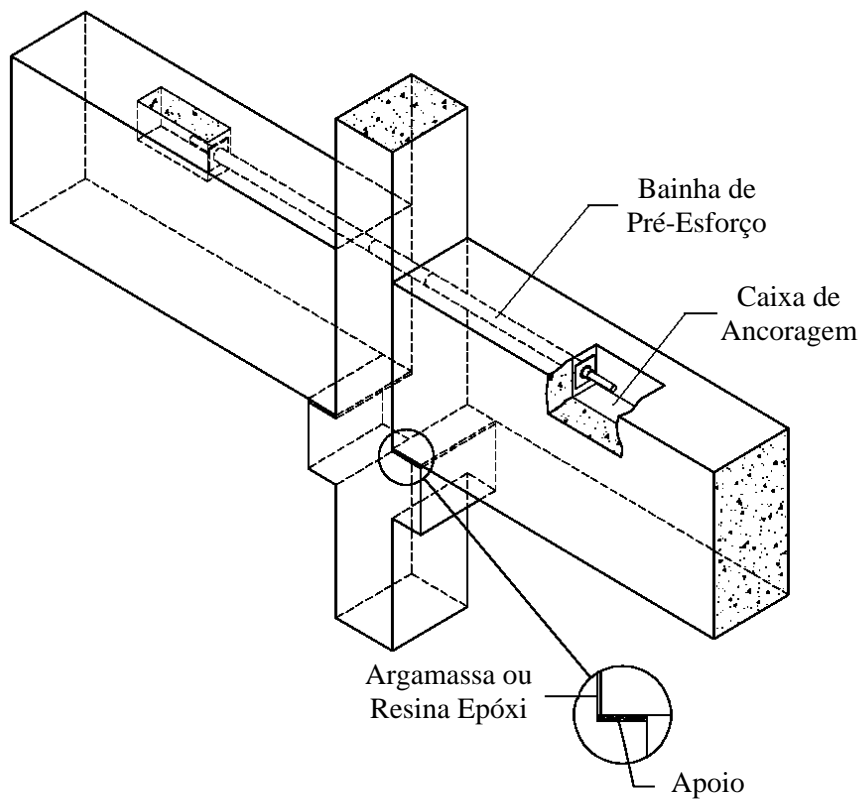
Ligação viga - pilar com pré-esforço, adaptado de [21]
